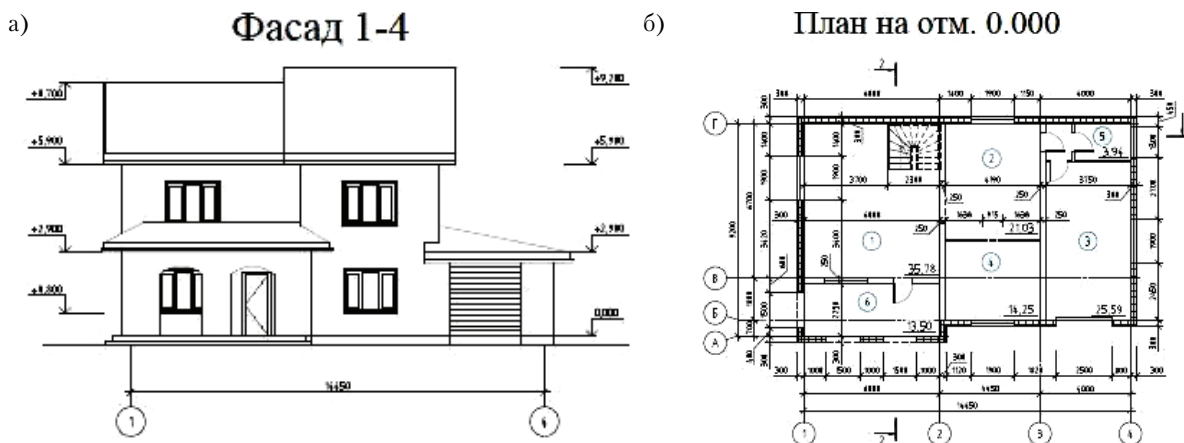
Архитектурно-планировочное решение коттеджа (план и фасад).
